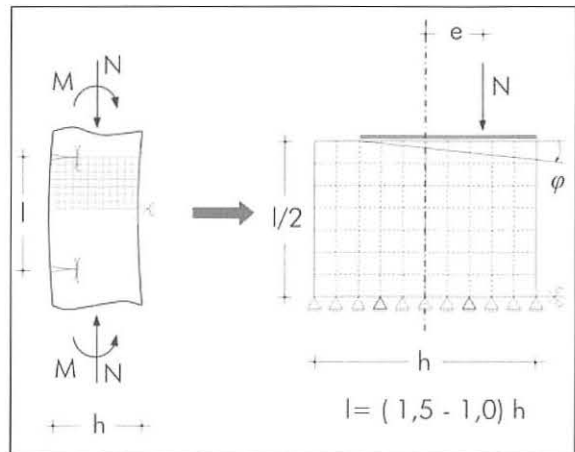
Berechnungsmodell gerissener Betonstab
